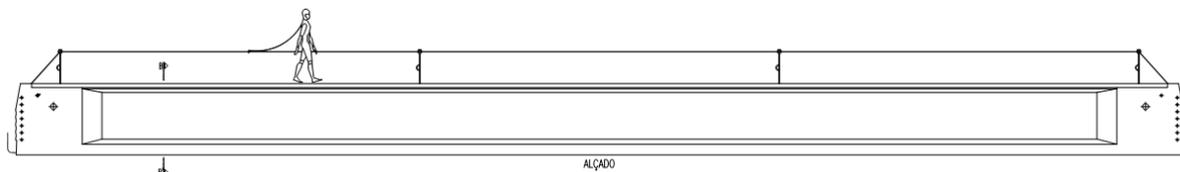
Pormenor linha de vida instalada no banzo da viga
